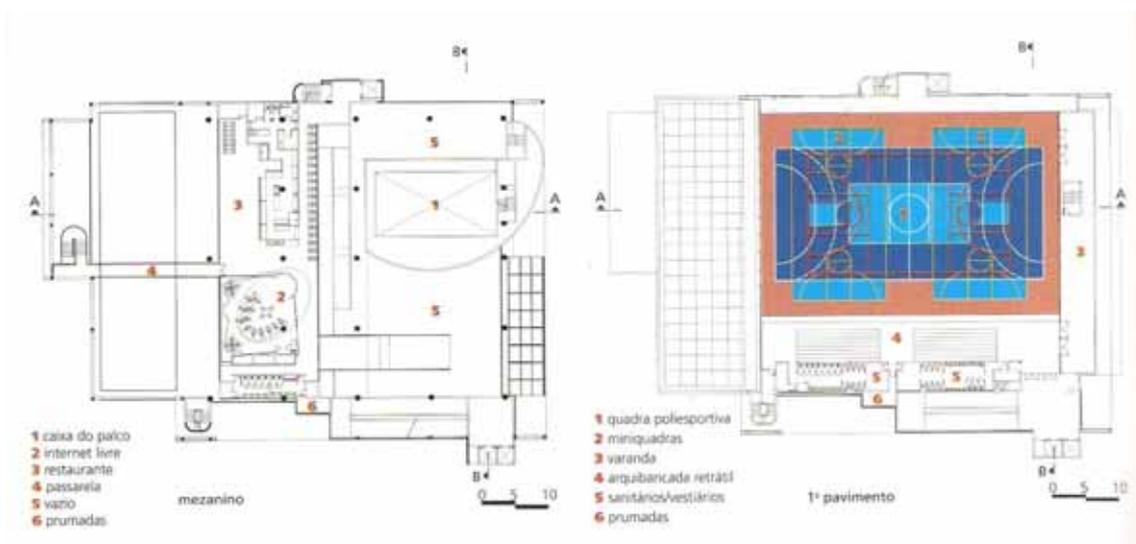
Plantas: mezanino e 1º pavimento. Fonte: Leal (2005)
